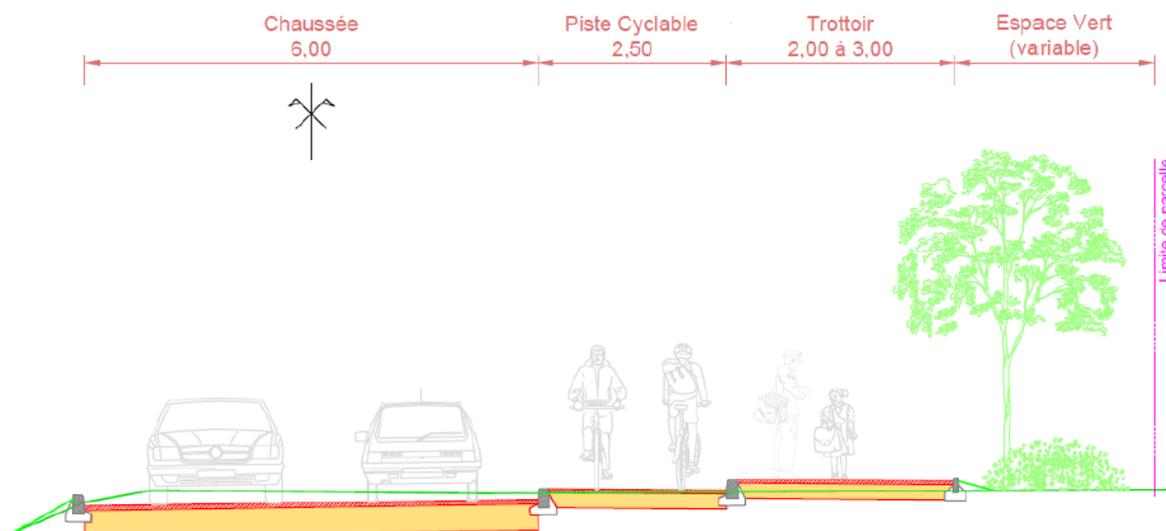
Coupe de principe sud-nord du barreau Marcellin Allo (stade études préliminaires)
